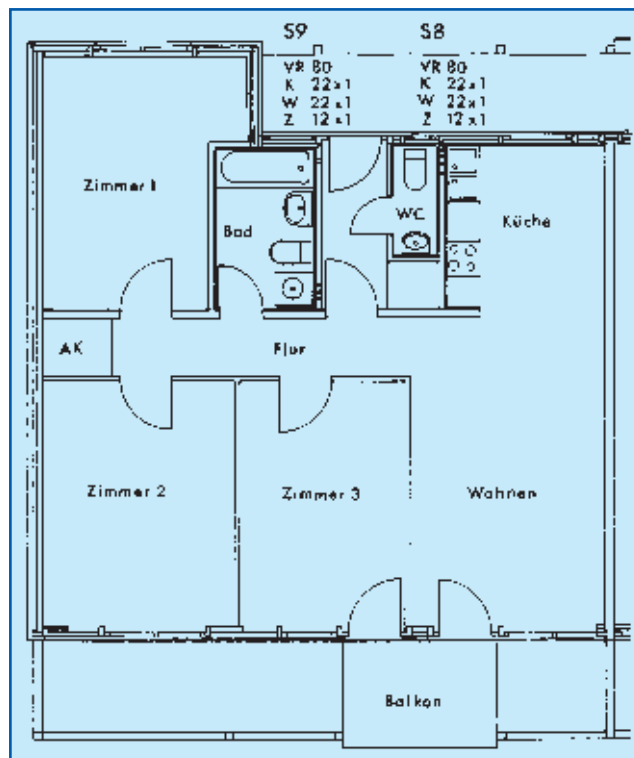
Grundriß der Vierzimmerwohnung in Luckau, mit Bad, WC und Küche
